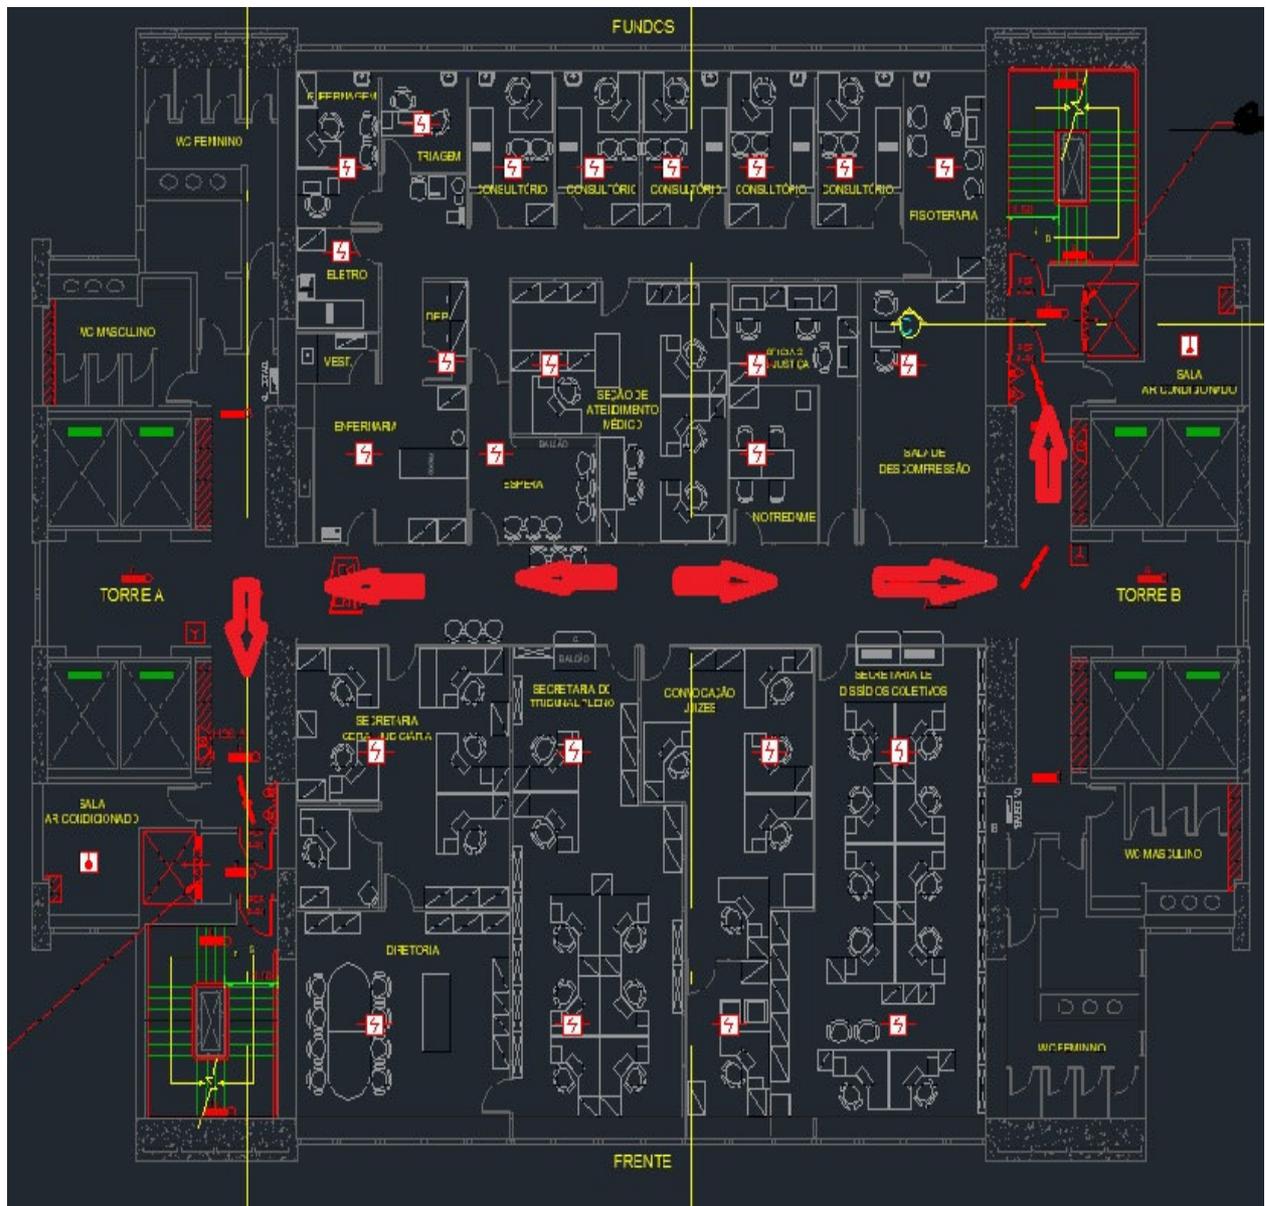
Ilustração da rota de fuga dos pavimentos da edificação
